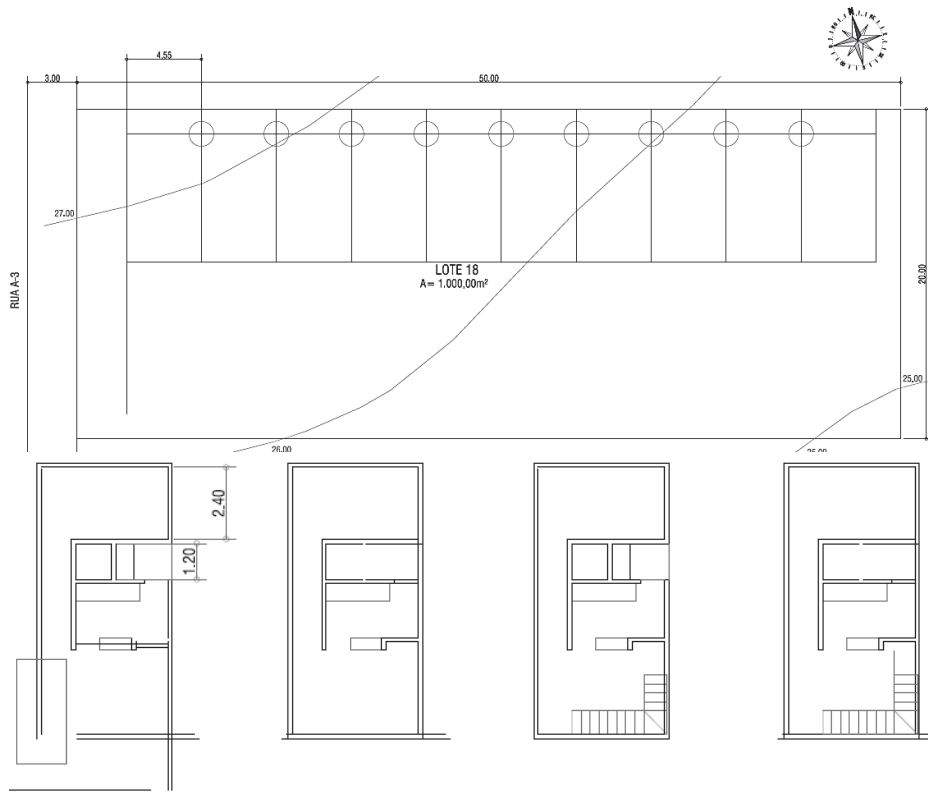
Implantação e plantas baixas da UH – Profissional 05, Exercício 02.
